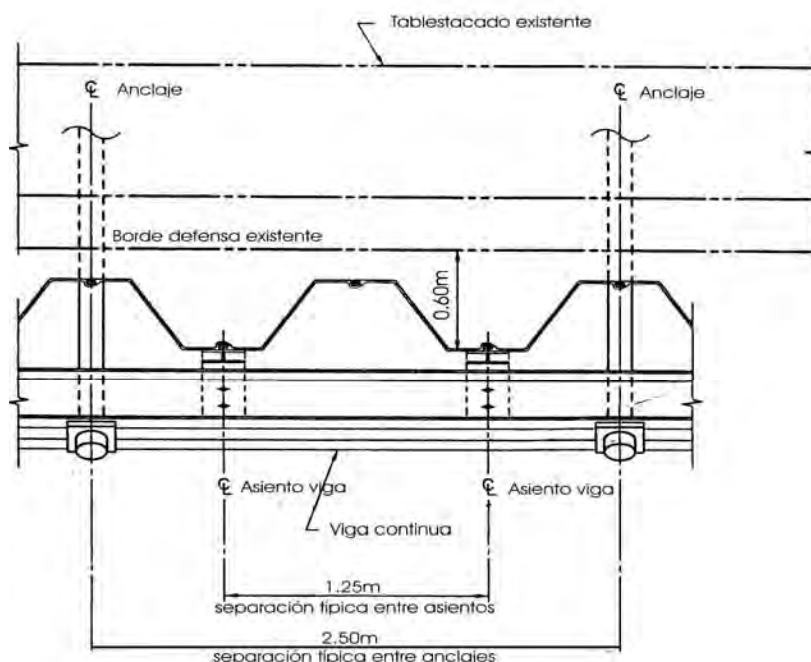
DETALLE TABLESTACADO NUEVO Y VIGA DE ARRASTRAMIENTO DE ANCLAJES
